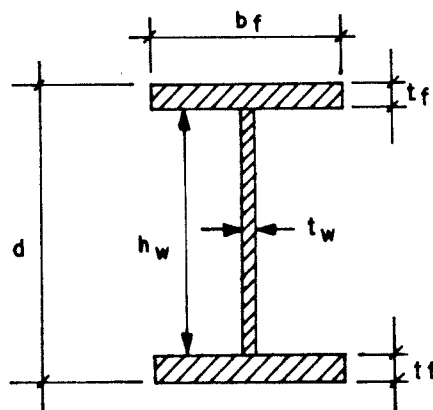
Perfil soldado de mesas iguais
